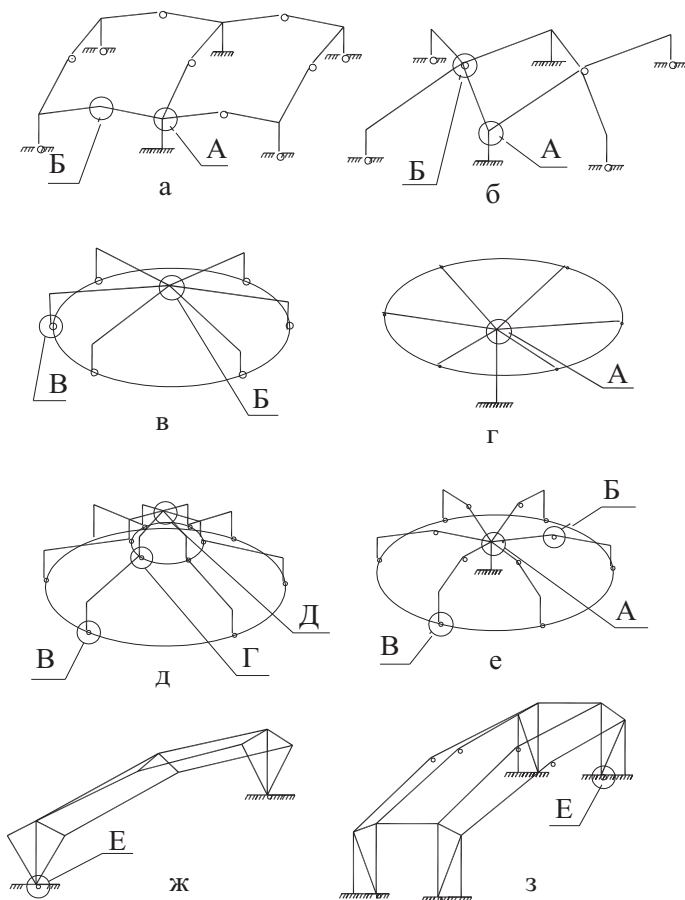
Конструктивні схеми каркасів споруд із залізобетонних рам: а - блок-модуль з чотирьох рам; б - блок-модуль з двох рам; в - схема каркасу круглого в плані; г - схема каркасу круглого в плані з єдиним стояком; д - схема каркасу круглого в плані типу башта; е - схема каркасу круглого в плані з центральним стояком; ж - схема каркасу з трьох рам; з - схема каркасу з чотирьох рам; А, Б, В, Г, Д, Е - вузли з'єднань елементів каркасу
